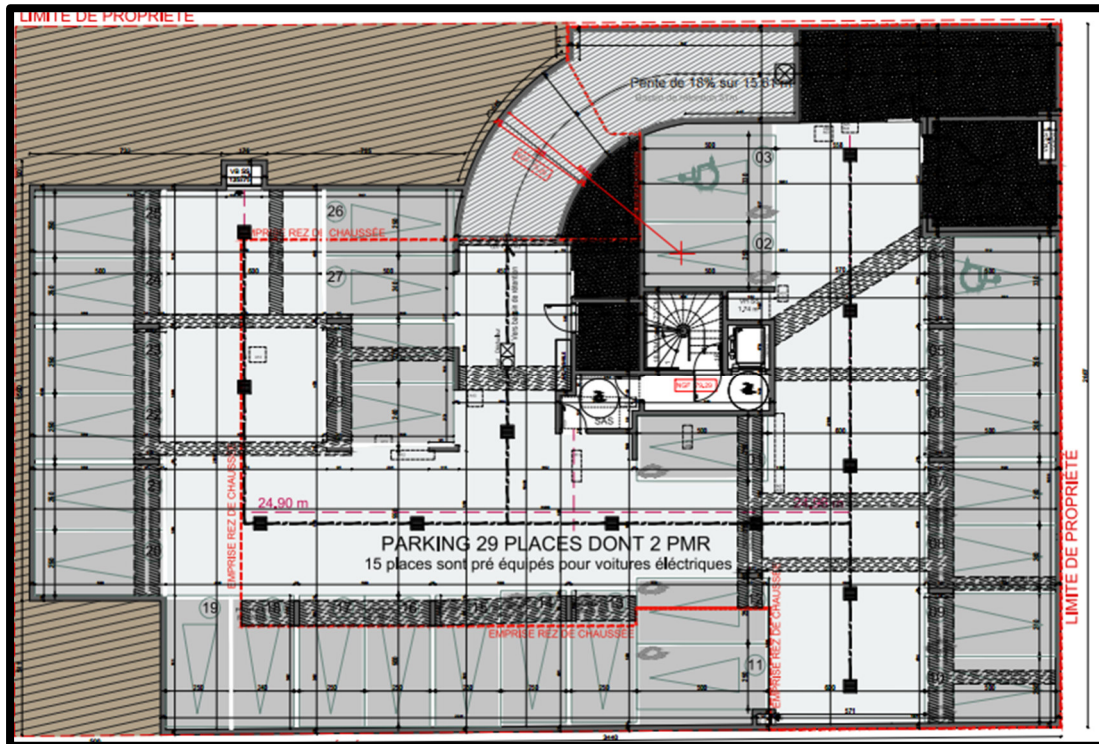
Planta Sub-Solo do edifício de estudo (fase projeto)
